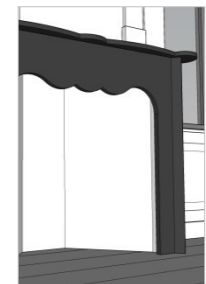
Overzichtsfoto schoorsteenmantel, bijv. foto (11)
